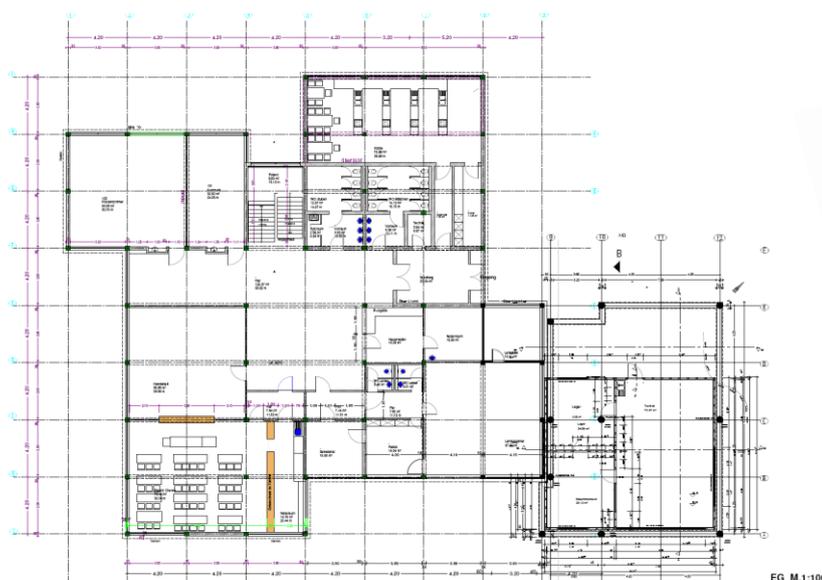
Grundriss des Erdgeschoß mit Verwaltungsbereich und Sondernutzung.
